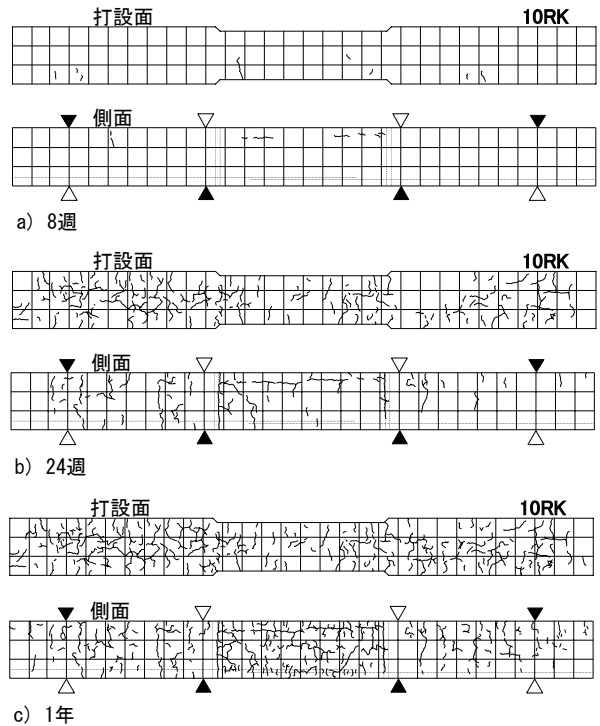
乾燥収縮ひび割れの進展状況の例示
